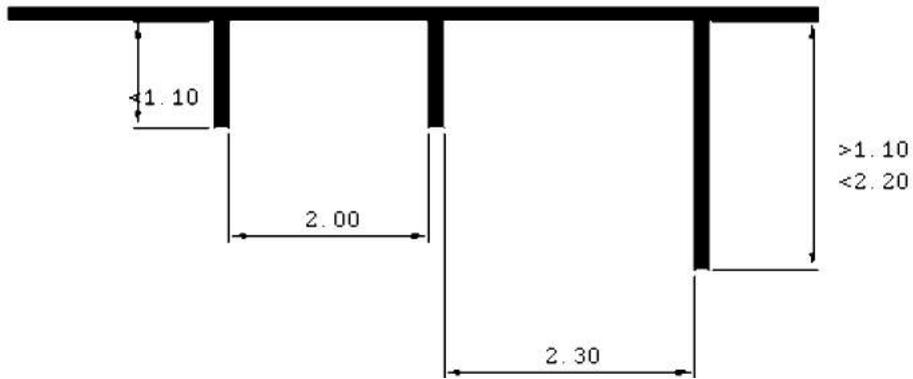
Détail du fond d'emplacement (stationnement à 90°)
